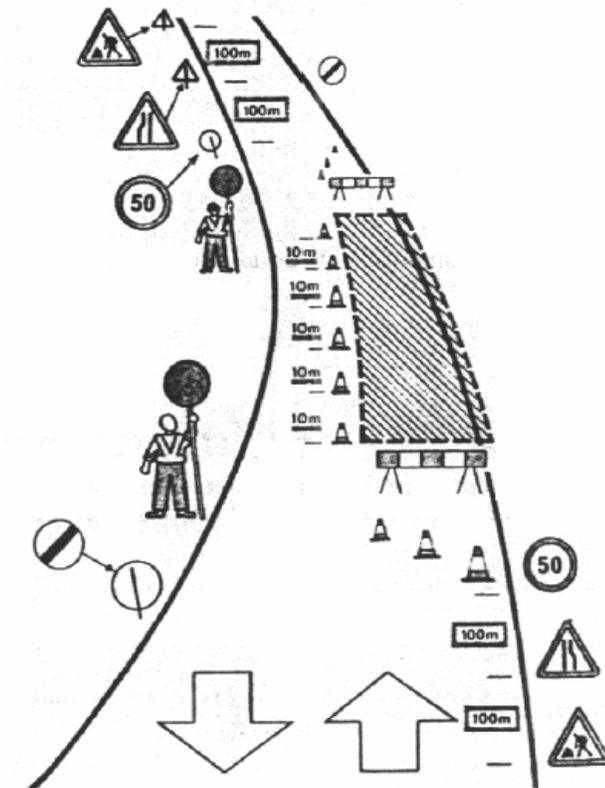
Disposición de señales temporales en la reparación de calzadas no pavimentadas.
